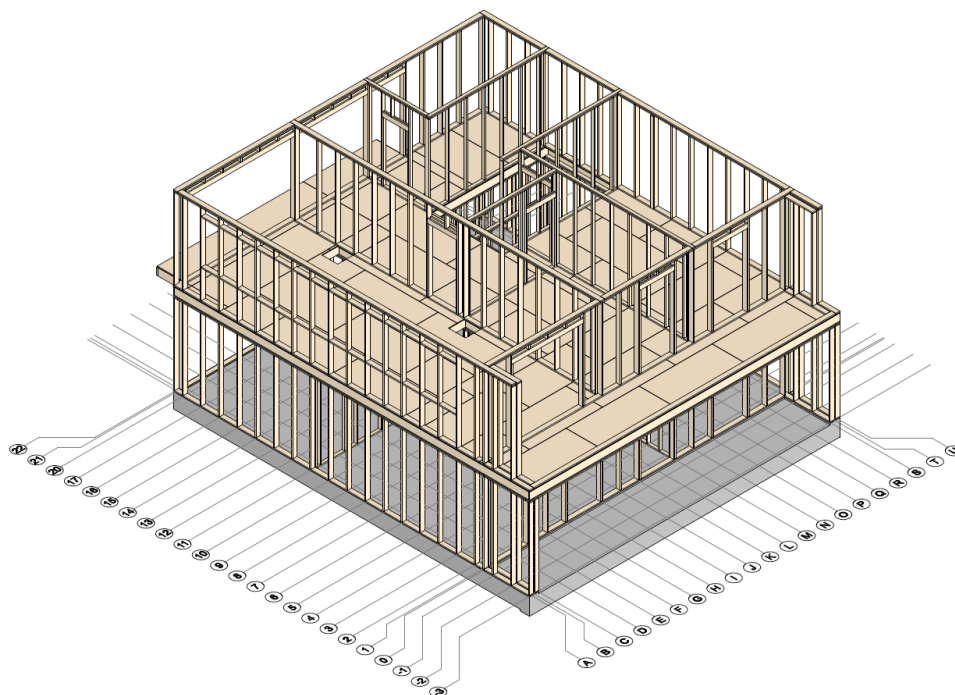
Axonometria estrutural com o piso térreo e as paredes do piso 1.
